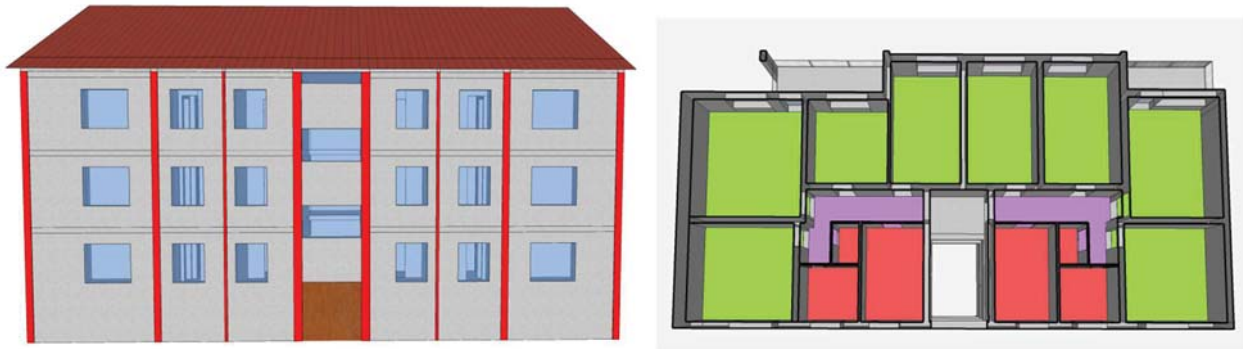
Vorderansicht des GK3-Gebäudes mit den an die Außenwände angrenzenden Innenwänden in Rot (links) und der dazugehörige Grundrissplan (rechts)
